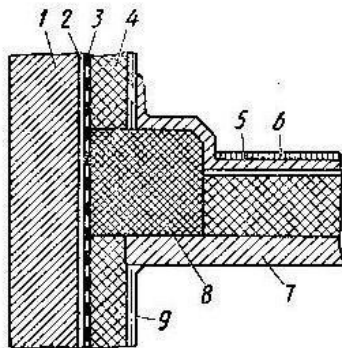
Примыкание междуэтажных перекрытий к наружным стенам:
